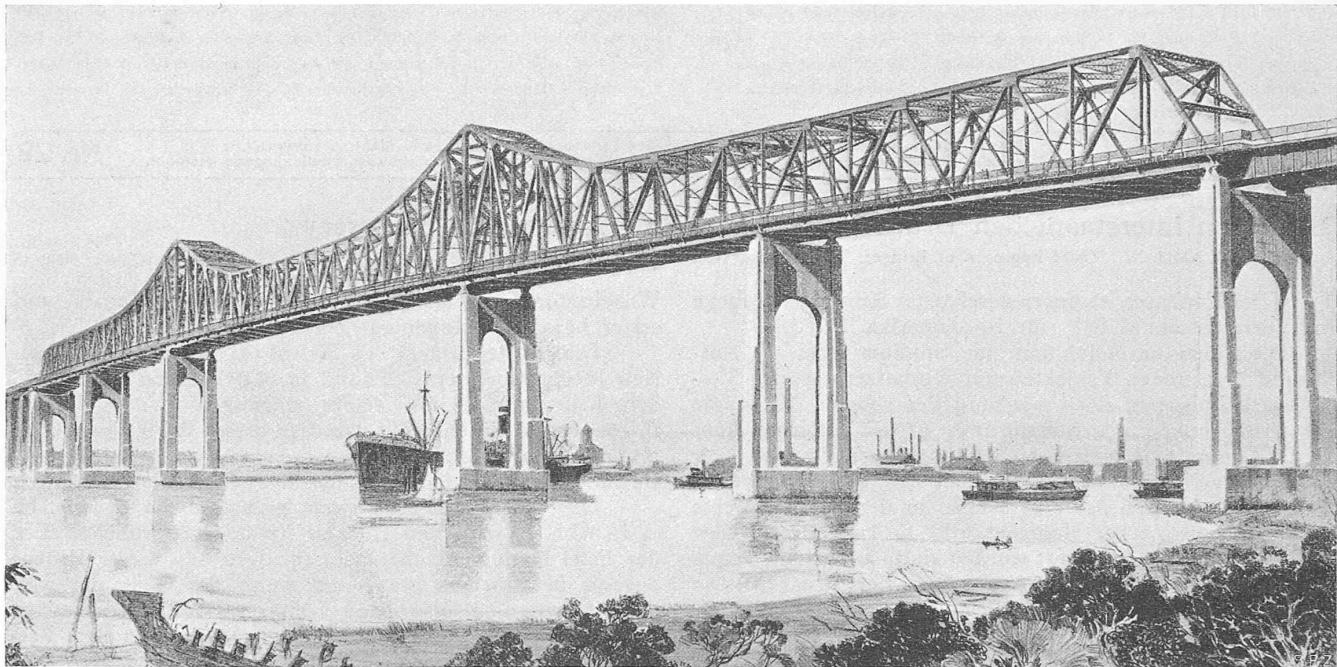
Südliche Brücke „Outerbridge Crossing“ über den Arthur Kill. Mittelöffnung 228,6 m, Brücke 640 m, mit Anfahrviadukten rund 3200 m.
